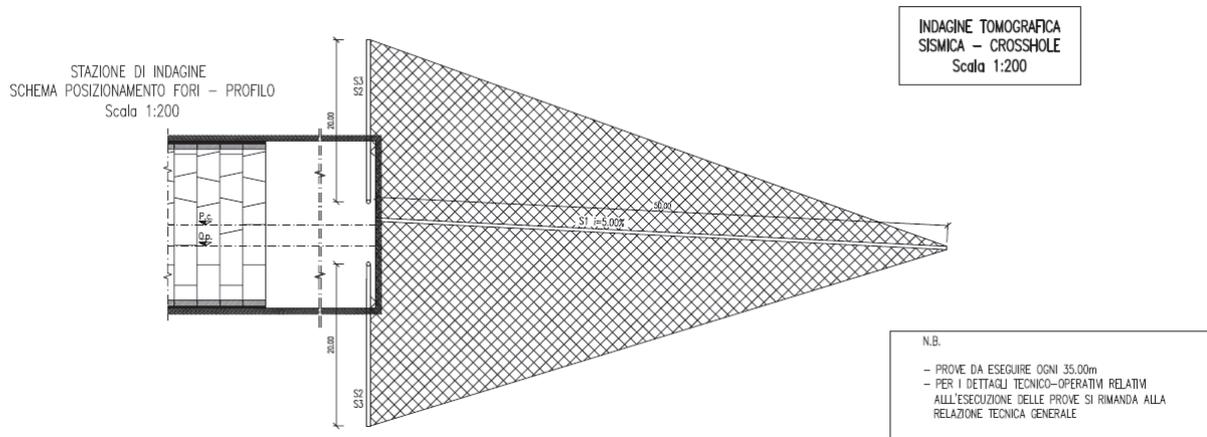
Indagini sismiche in avanzamento. Schema in planimetria
